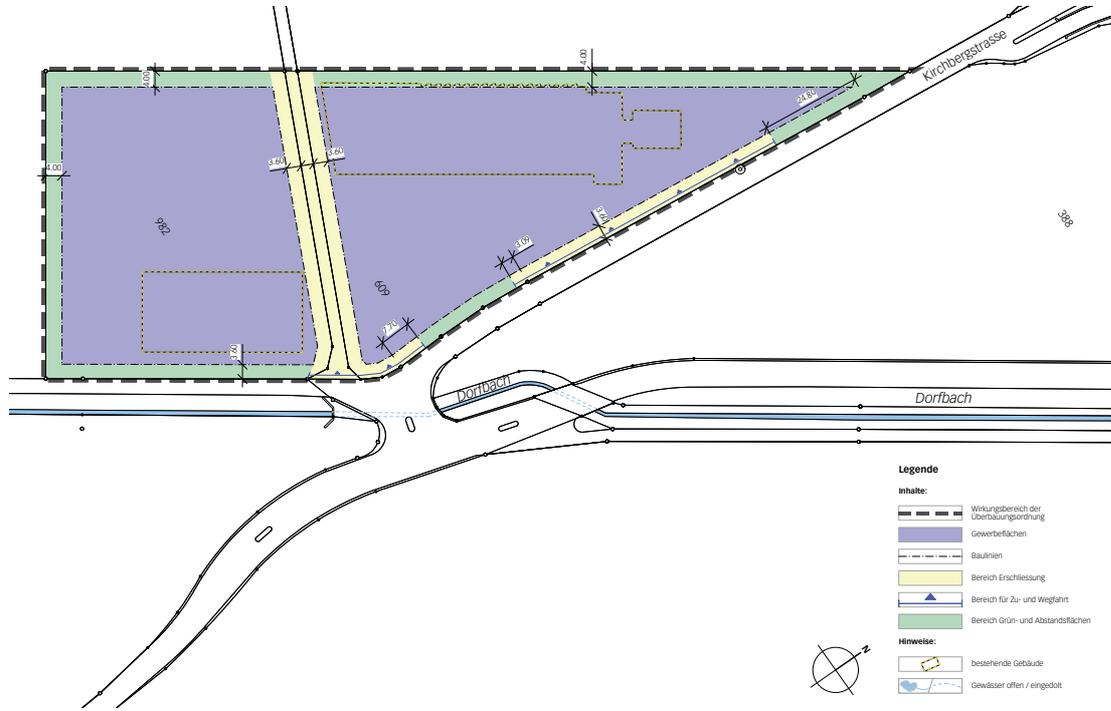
Ausschnitt Überbauungsplan mit Legende
